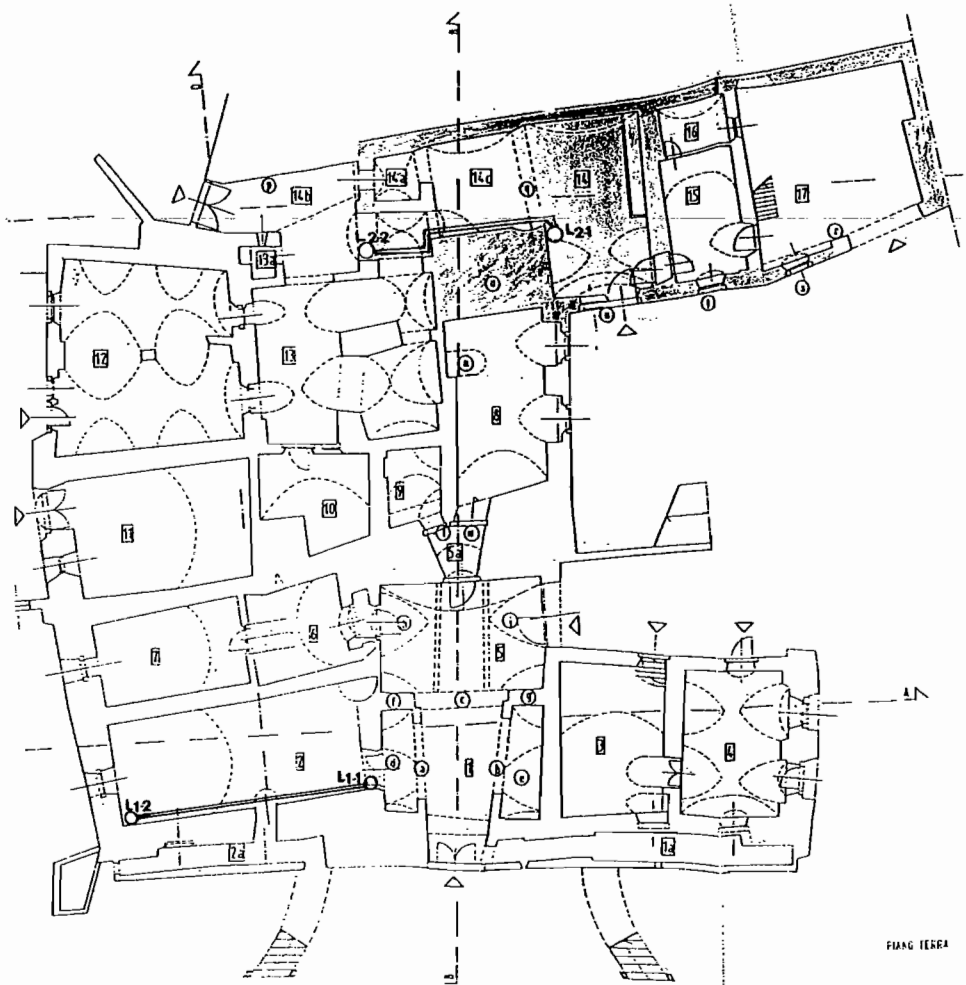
Ubicazione planimetrica della strumentazione al piano terra.
